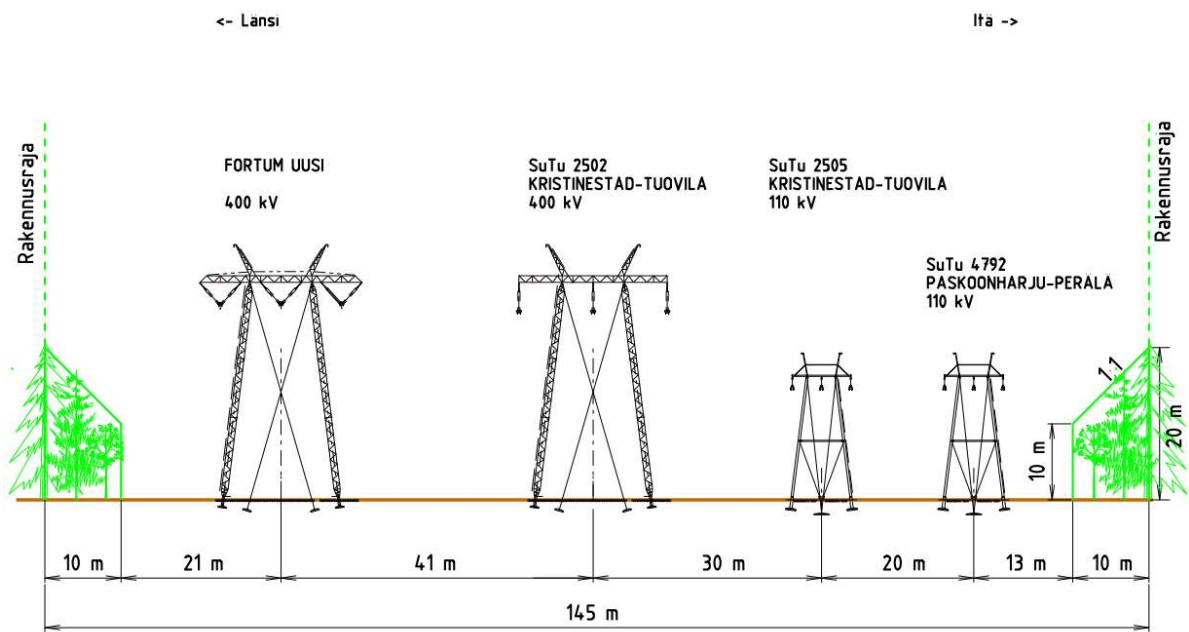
Planerad elöverföringslinje till Kärppiön elstation.
